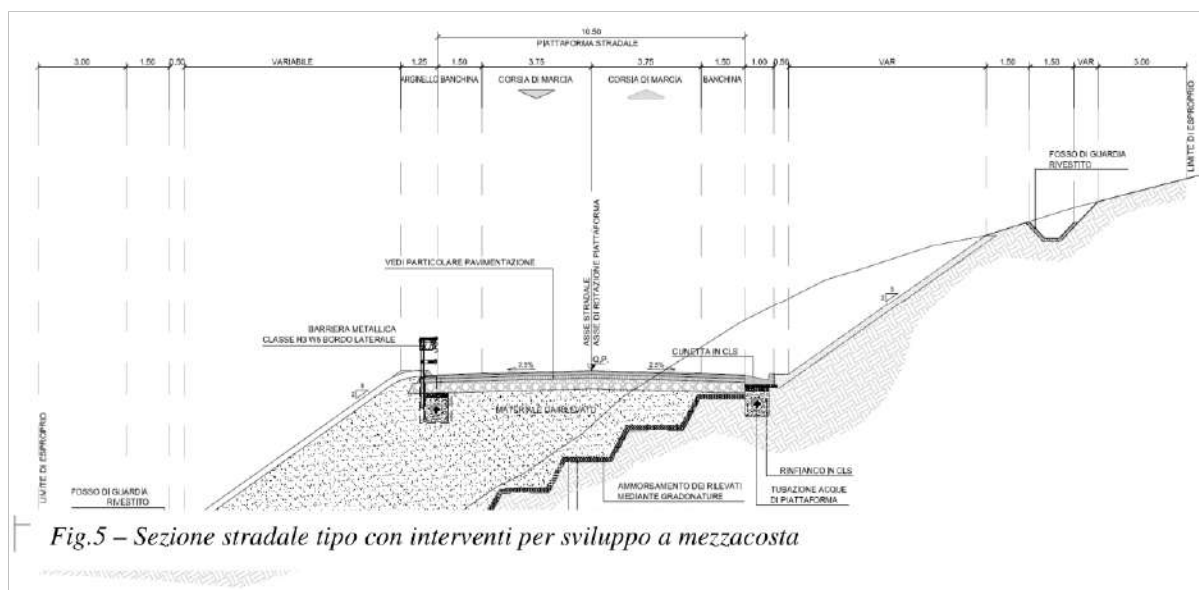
Sezione stradale tipo con interventi per sviluppo a mezzacosta
